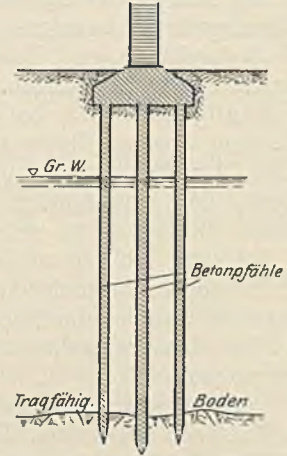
Hochliegende Pfahlgründung auf Betonpfählen.
